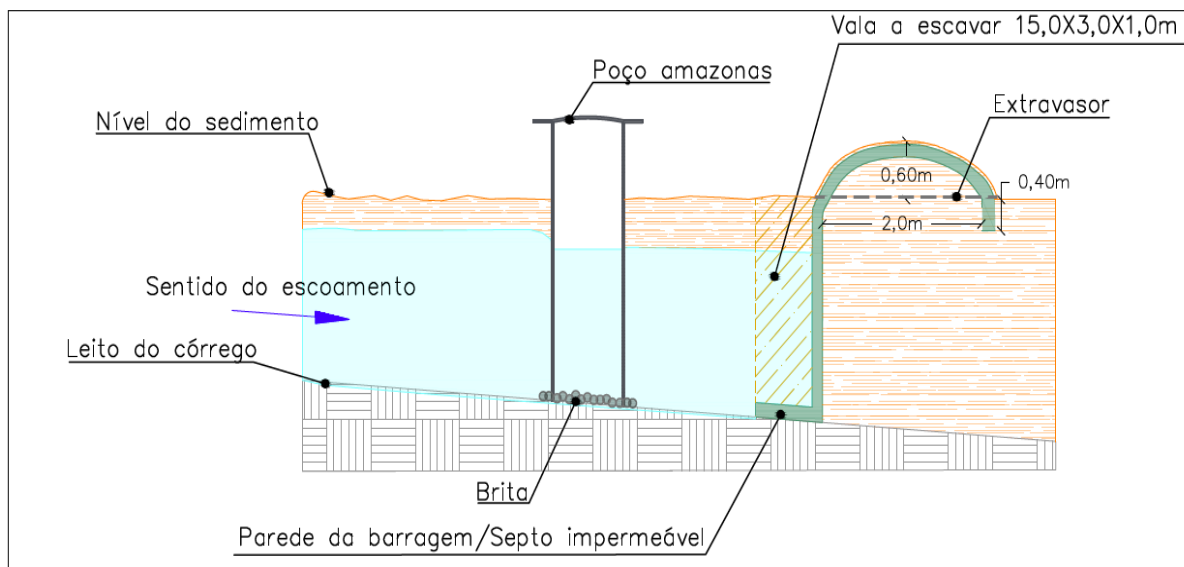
Desenho esquemático de implantação de Barragem subterrânea.
